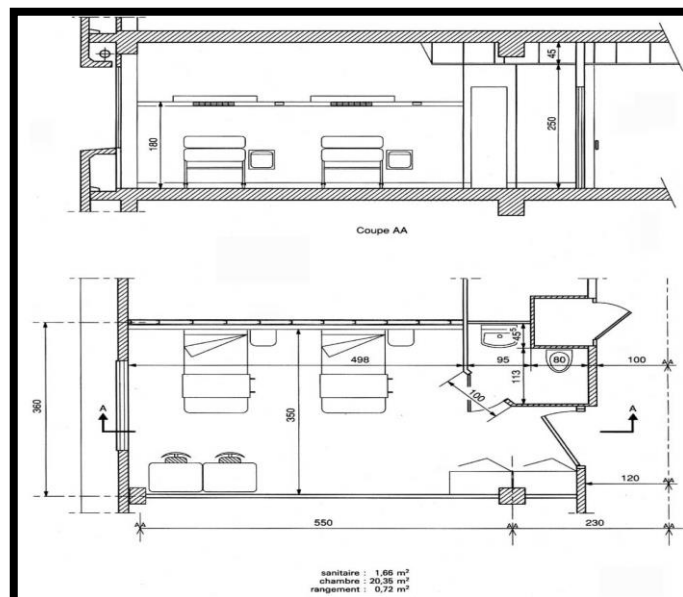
Plan et coupe schématique d'une salle d'hospitalisation de 2 lits. [Source : neufert 2008]
